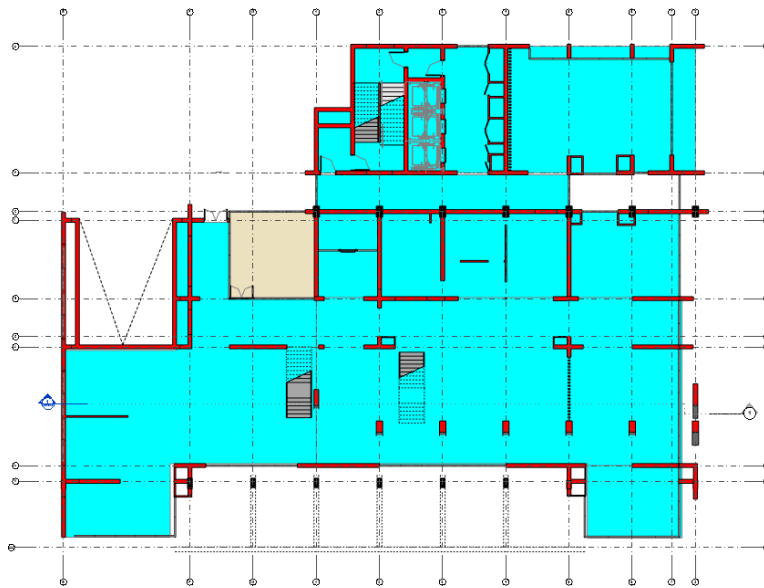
esquema estructural, piso 1, en rojo los muros estructurales, en cian, diafragmas estructurales.
